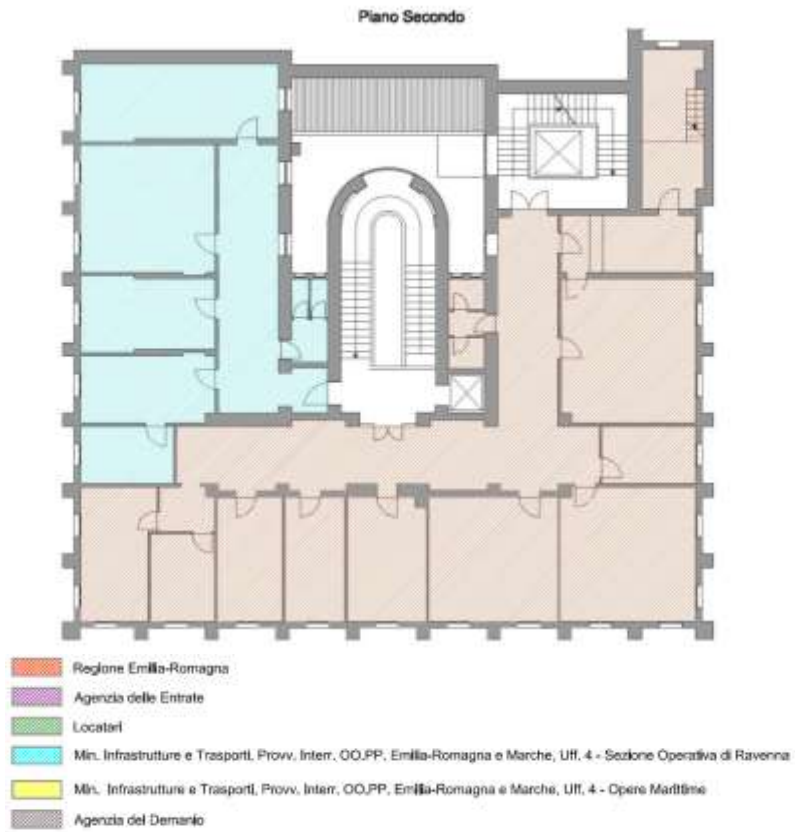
Pianta degli spazi occupati: piano secondo.
